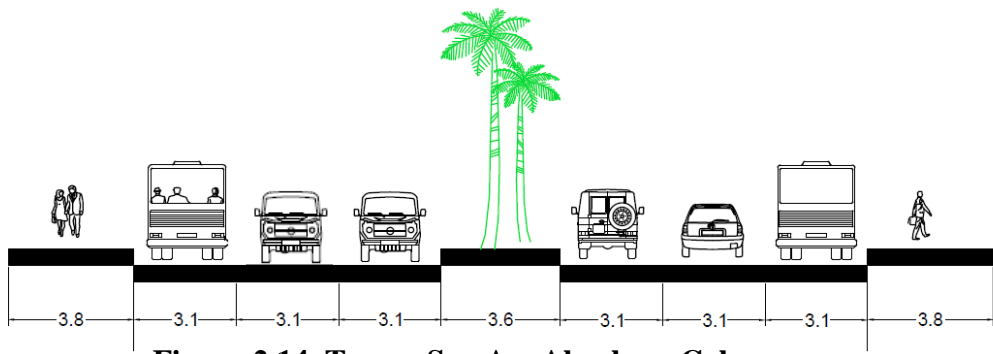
Tramo Sur Av. Abraham Calzacon.
